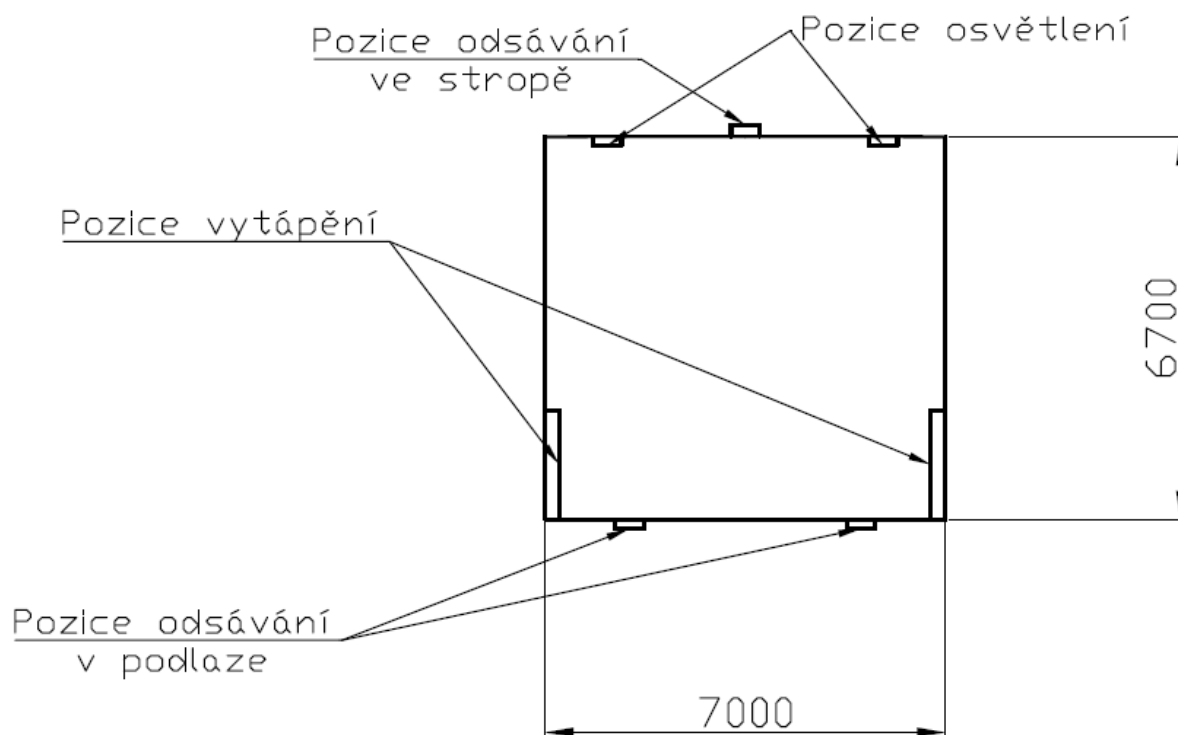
Základní rozměry lakovacího stanoviště
